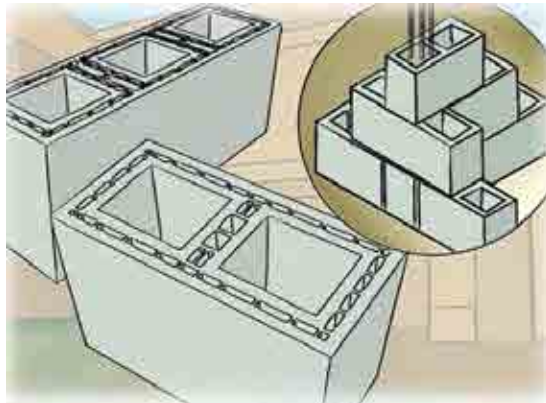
Ilustração de Alvenaria Estrutural parcialmente armada: detalhe para a prumada que se encontra armada, mostrando o elemento de armadura passiva
